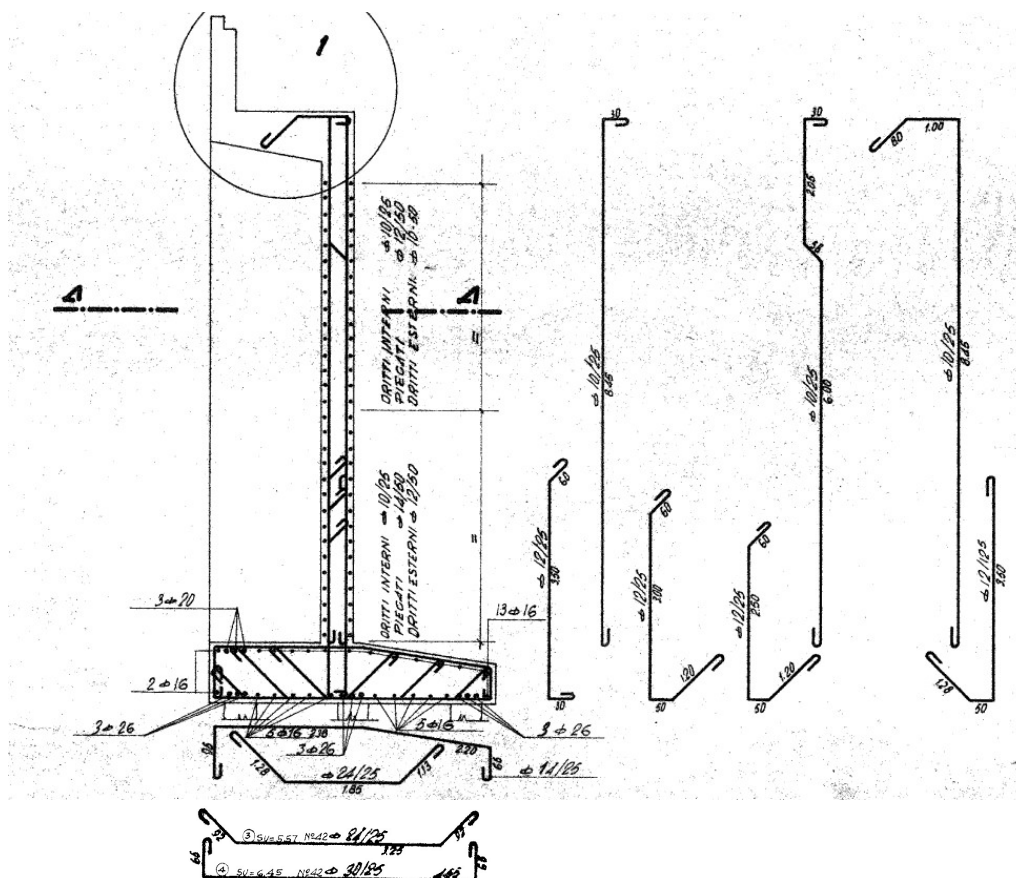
Documento as-built “Viadotto rampa interconnessione dell’autostrada A14 al km 14+346” – Sezione trasversale con armature spalla.
